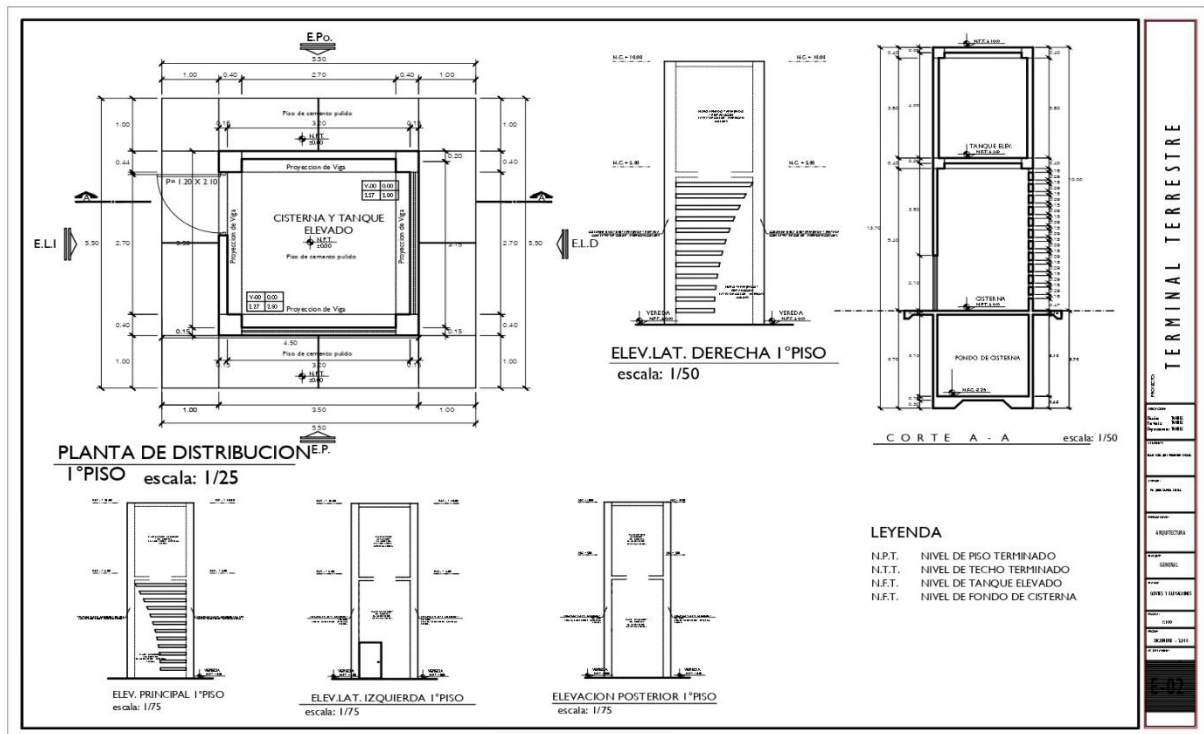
Planta de distribución 1° piso. Elaboración Propia
